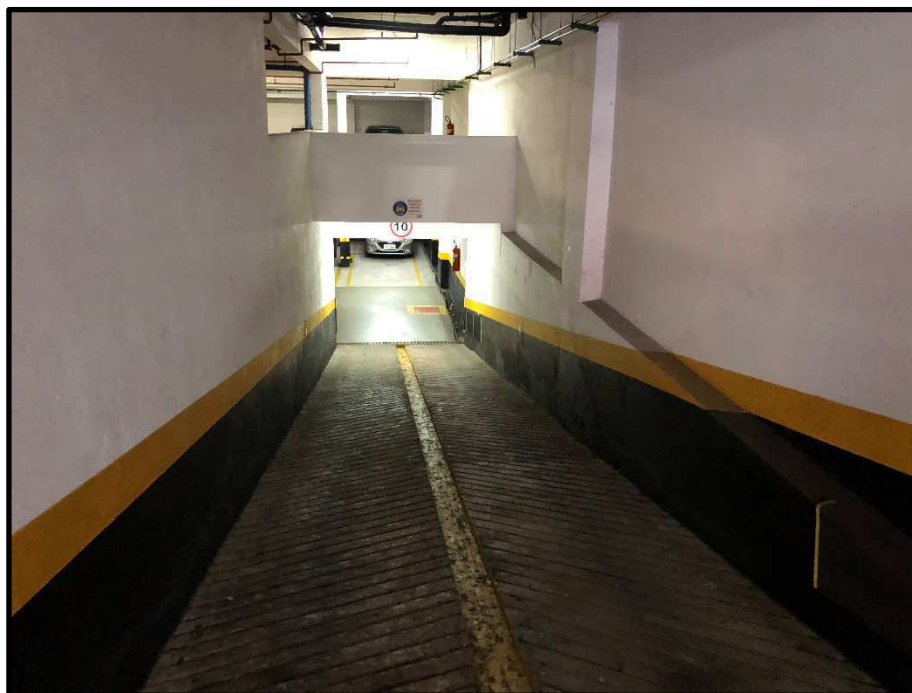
Rampa de acesso do 1º para o 2º subsolo
